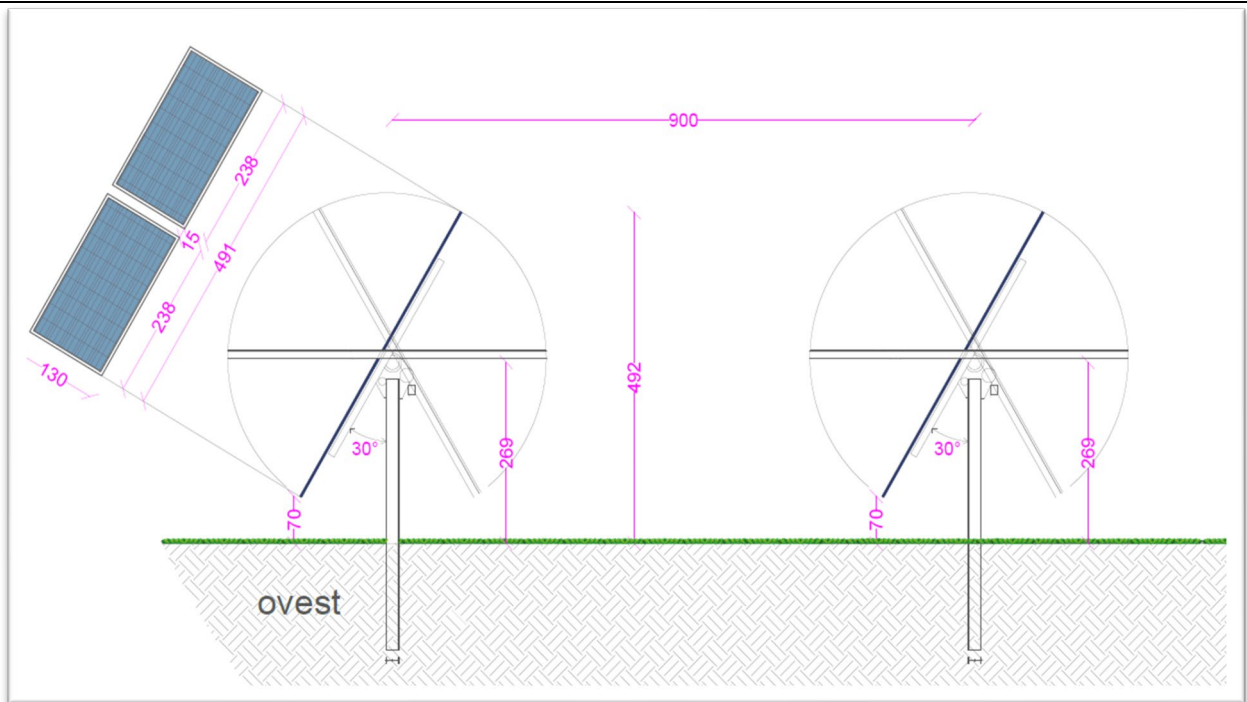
Sezione tipo impianto con installazione su sistema ad inseguimento solare tipo tracker
